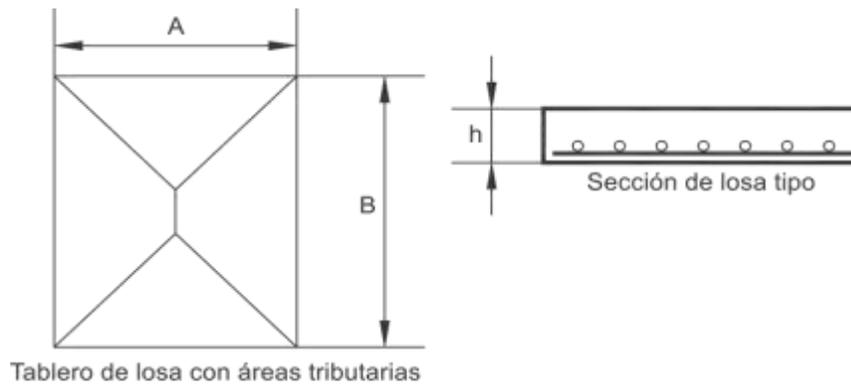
Norma empleada: *Standard specifications for tolerance for concrete construction*, ACI 117, sección 4.
